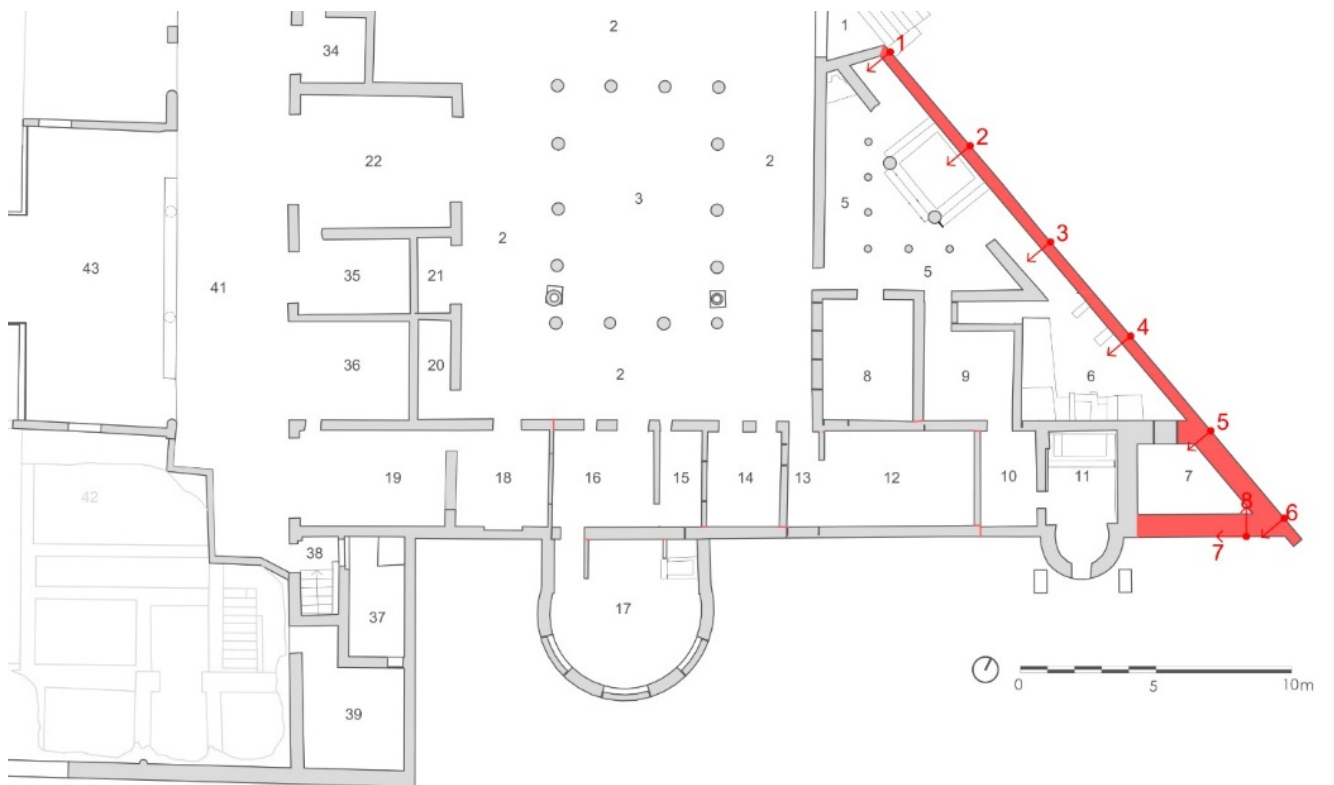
Localizzazione e disposizione accelerometri della prova ID_05
